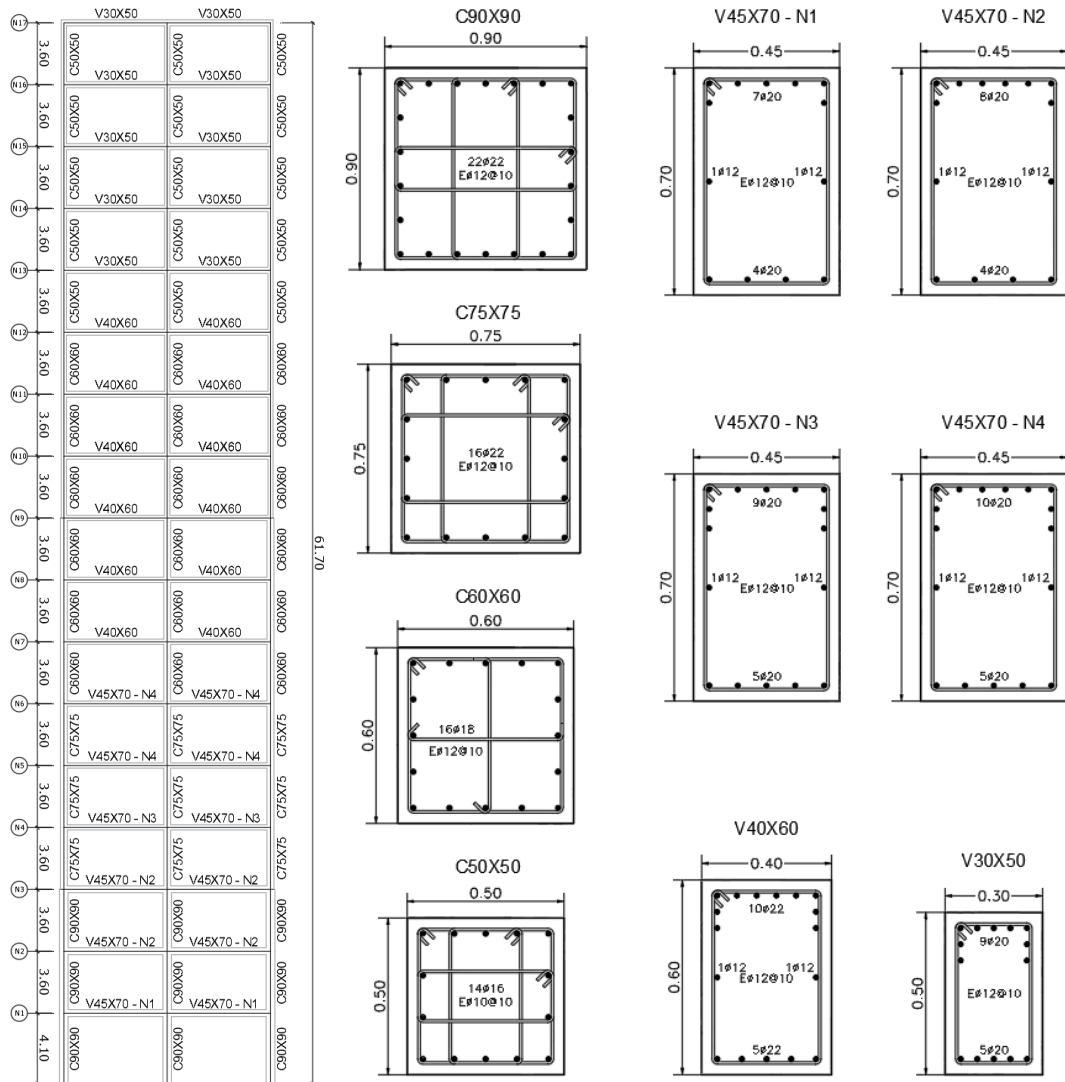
Distribución del acero de refuerzo longitudinal y transversal en las columnas y vigas del Plano A.
